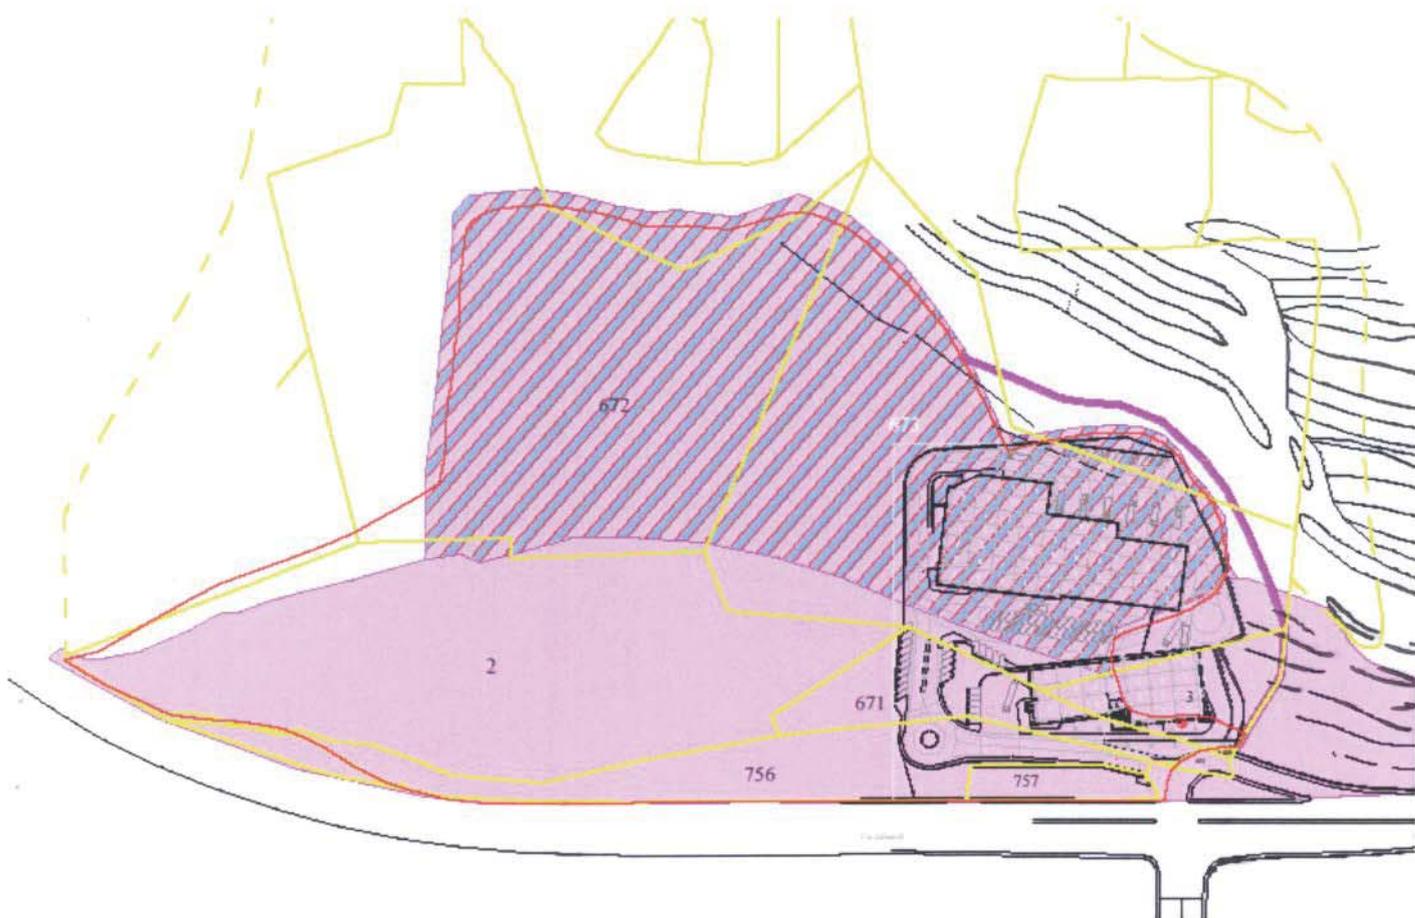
sovrapposizione PUC 2000 – PUC 2011 (colore rosso) perimetro ampliamento in colore magenta (osservazione)
